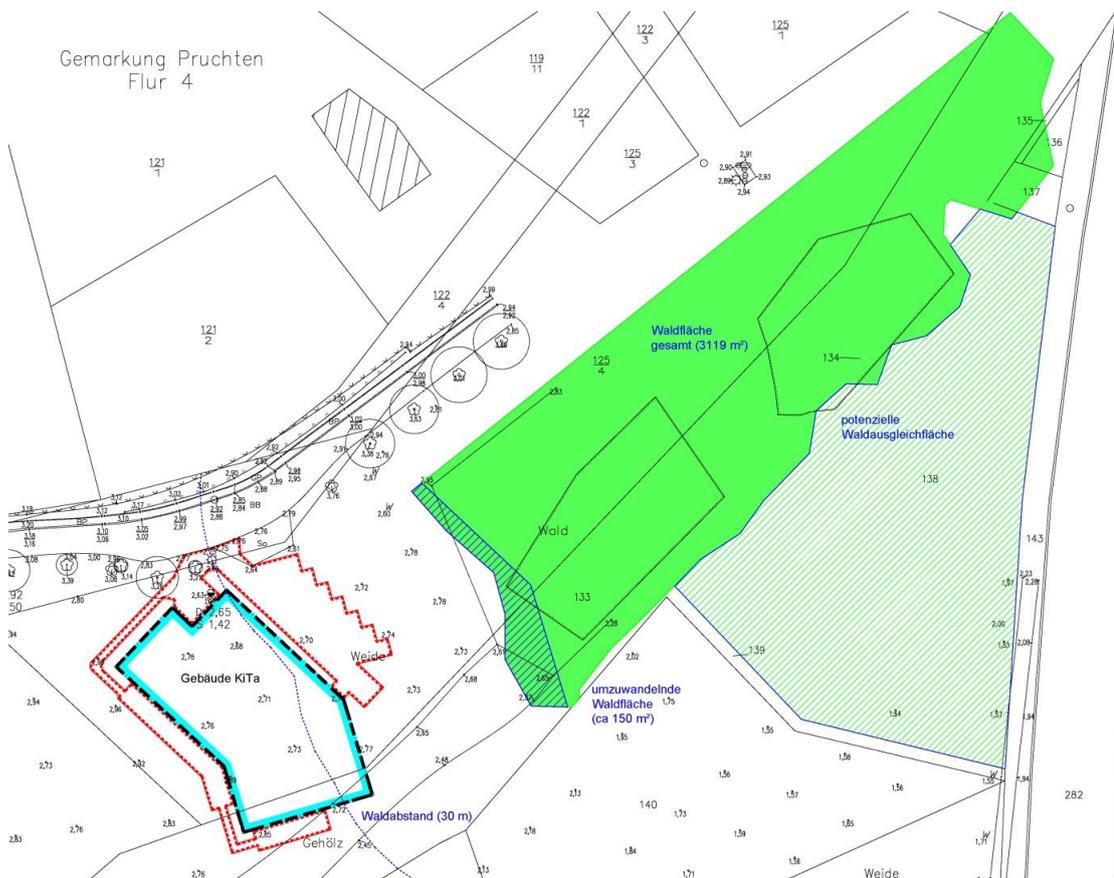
Entwurfsvariante der Kita mit optimierter Lage des Baukörpers und Reduzierung der umzuwandelnden Waldflächen
